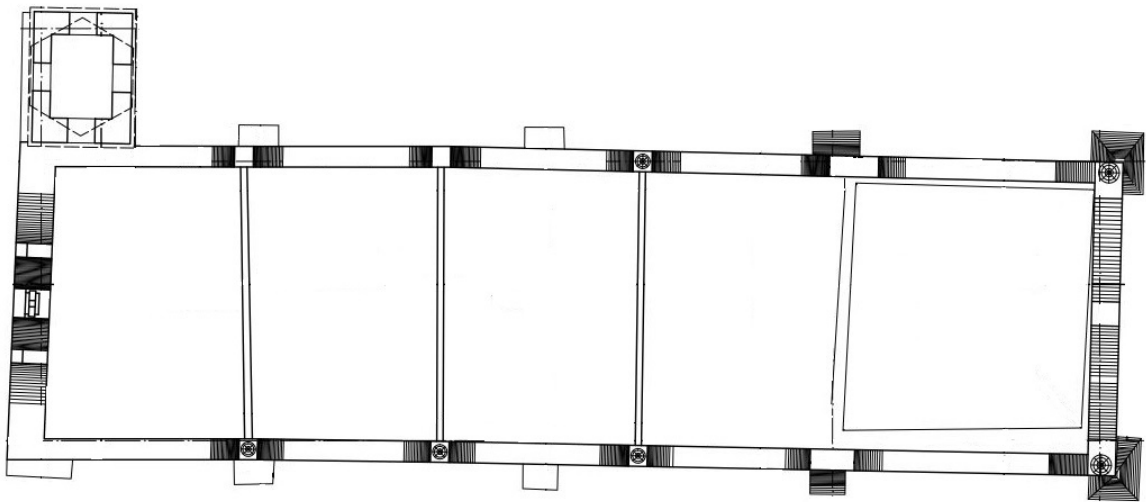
Vista en planta del templo de Santa María Nativitas [Gutiérrez, 2011]
